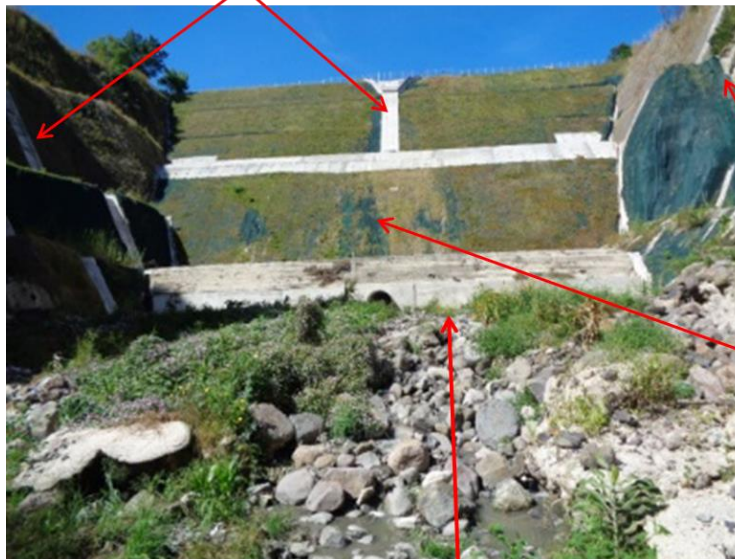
Sector de muro que retenía nivel de quebrada hasta Santa Lucía
